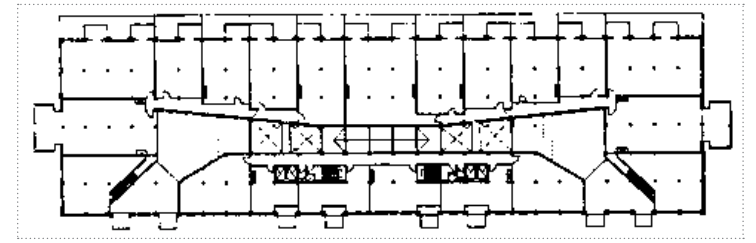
Planta 1º pavimento do Galpão 5, onde se distribuem as unidades habitacionais. Fonte: Revista Arquis nº 1.
